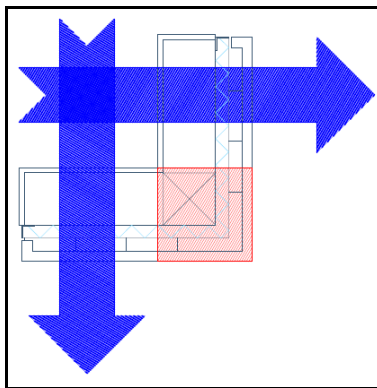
Troca de calor paralelas ao plano do elemento considerado
